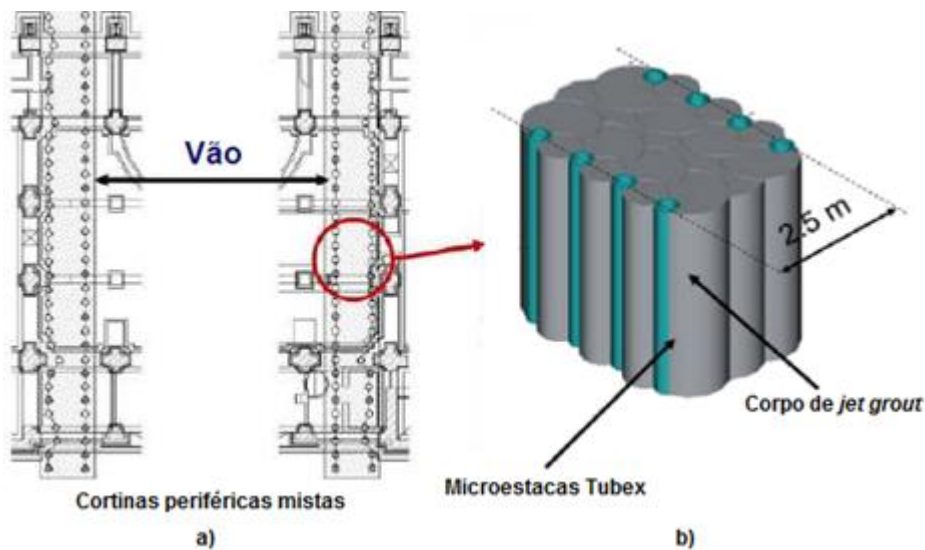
Esquemas da cortina: a) planta; b) pormenor [7]
